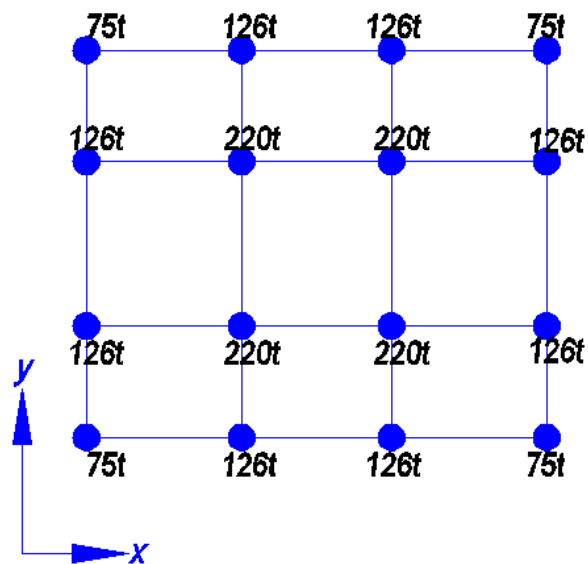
Magnitud de las cargas axiales que bajan a cada columna de la planta baja
